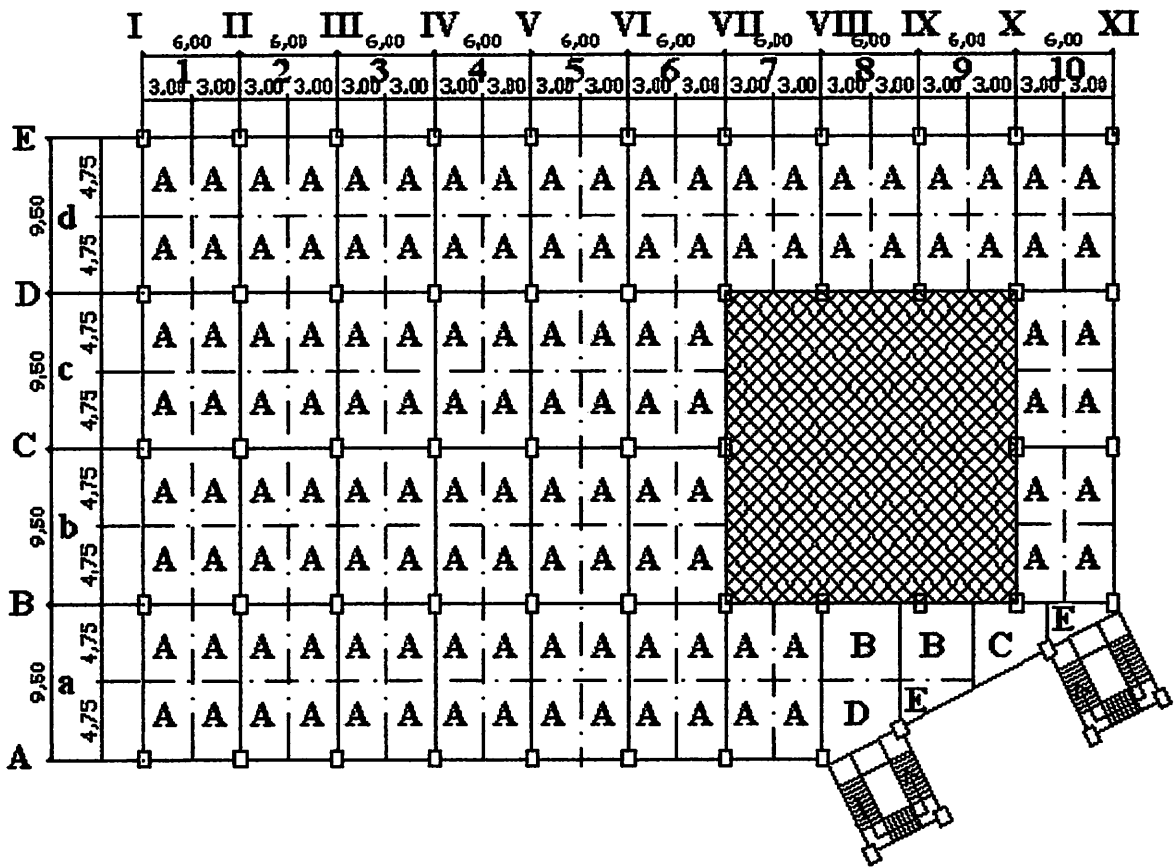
3b Dimensi Balok dan Kolom Lantai 2 - Atap
